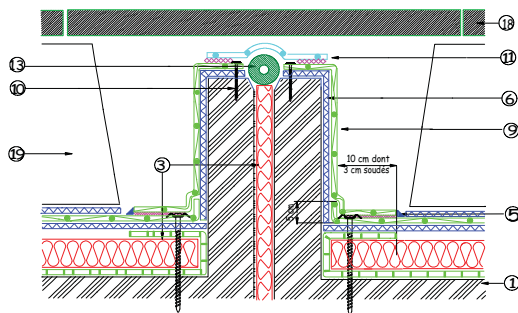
joint de dilatation plat surélevé sur maçonnerie avec dalles sur plots
